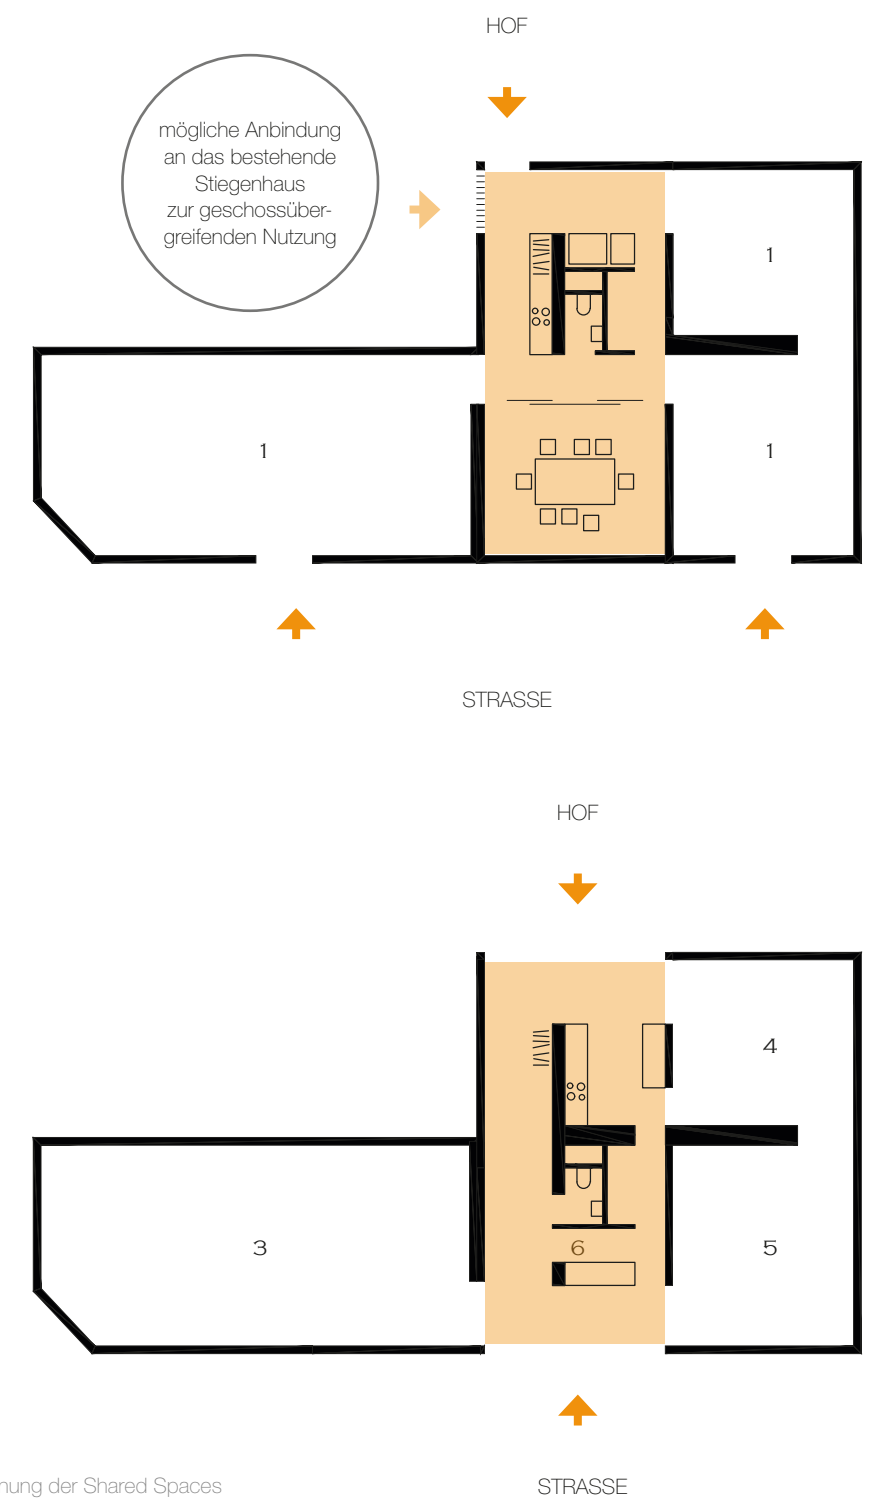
Grundrissbeispiele für die Planung der Shared Spaces
